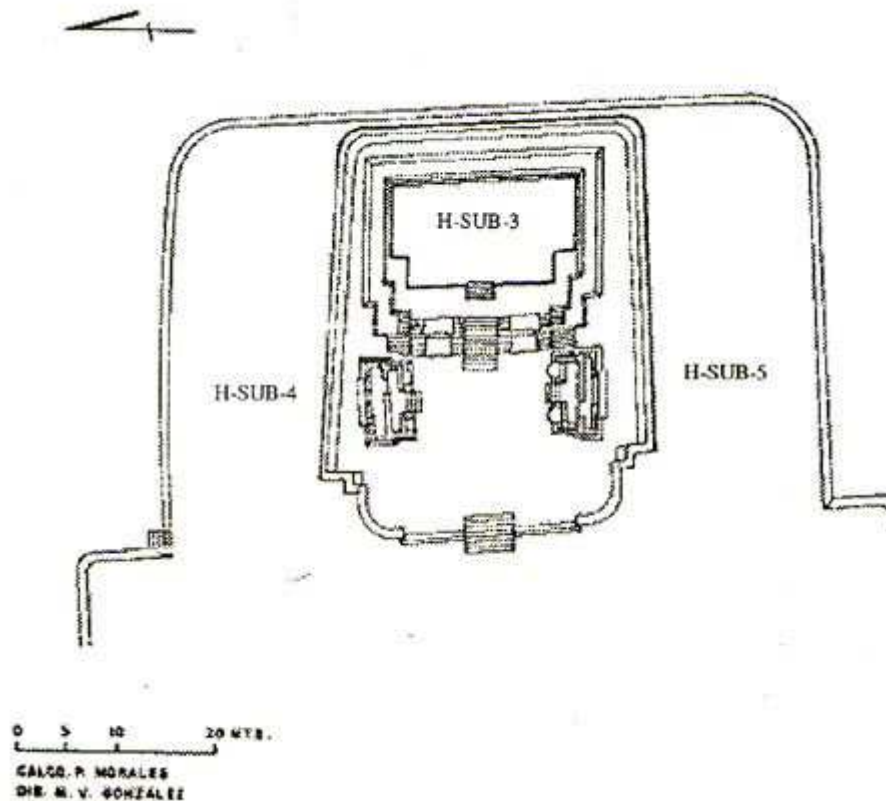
Planta Arquitectónica of FASE CONSTRUCTIVA Three, South Complex Acropolis, Group H, Uaxactún.
